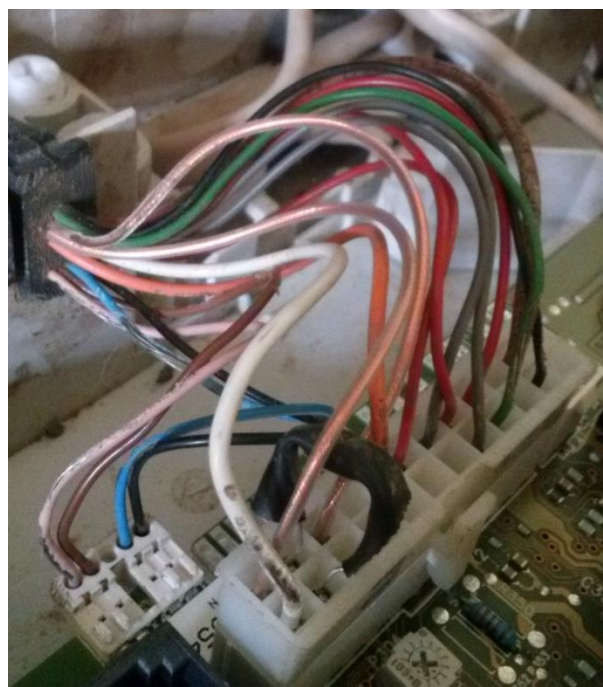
Изоляция электропроводки газового отопительного котла, поврежденная мышами
